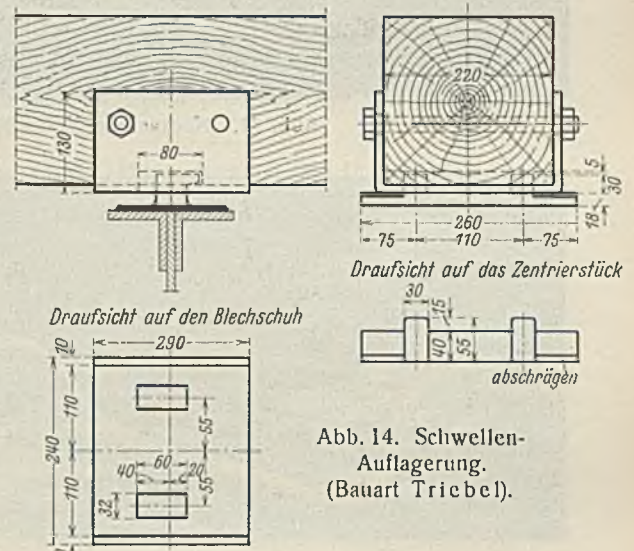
Schwellenauflagerung. (Bauart Triebel).
